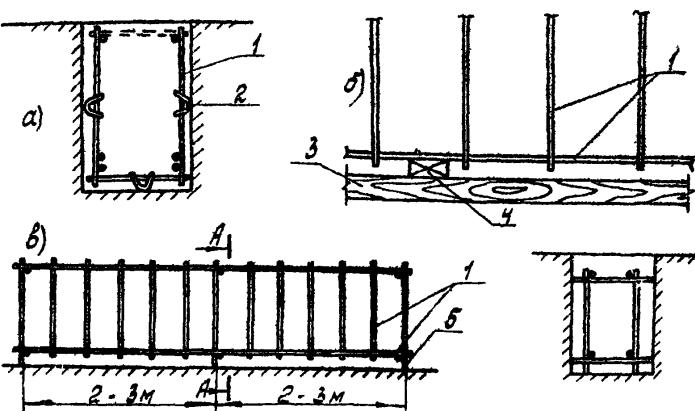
Способы обеспечения необходимого защитного слоя в железобетонных конструкциях
